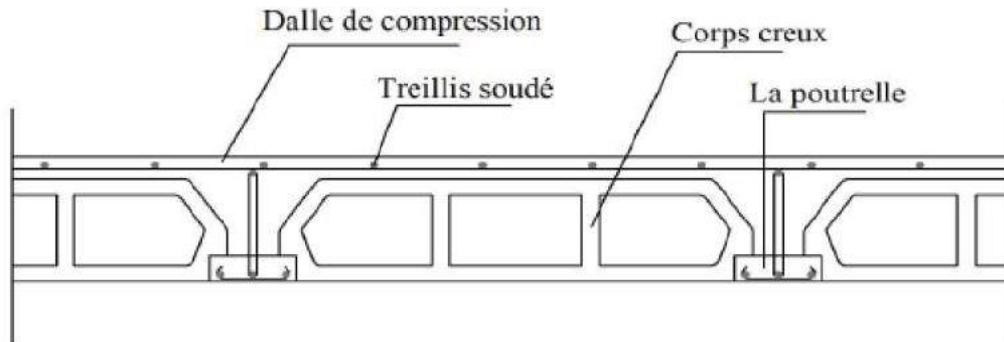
Schéma descriptif d'un plancher en corps creux.
